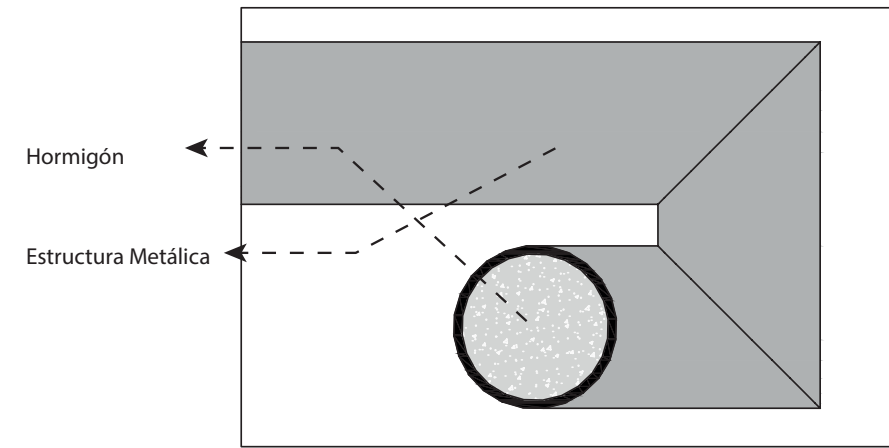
/ Detalle Constructivo Cimiento / Gráfico Propio
